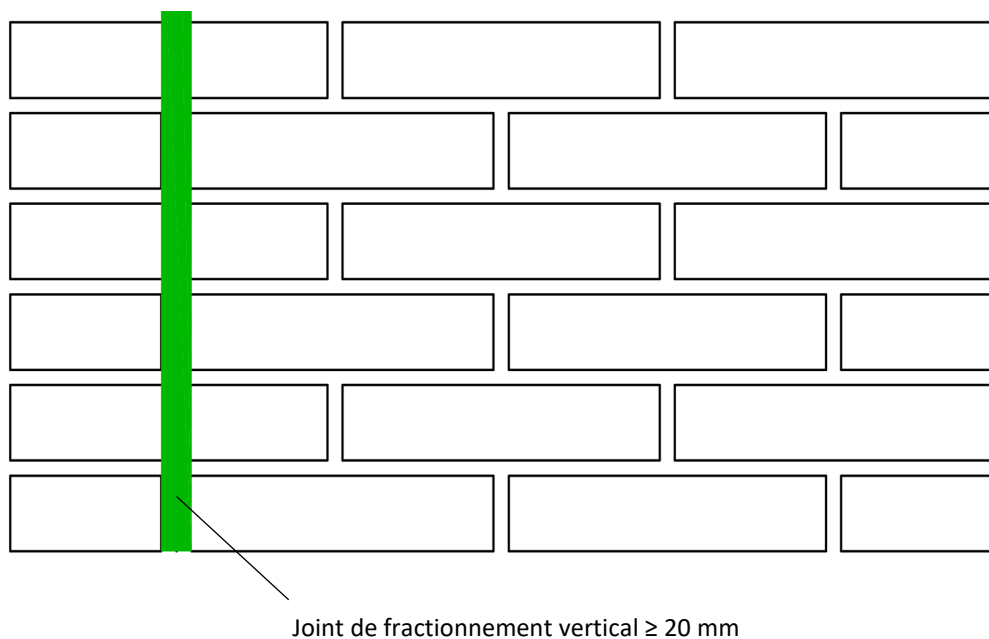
Joint de fractionnement vertical - coupe franche (façade)
